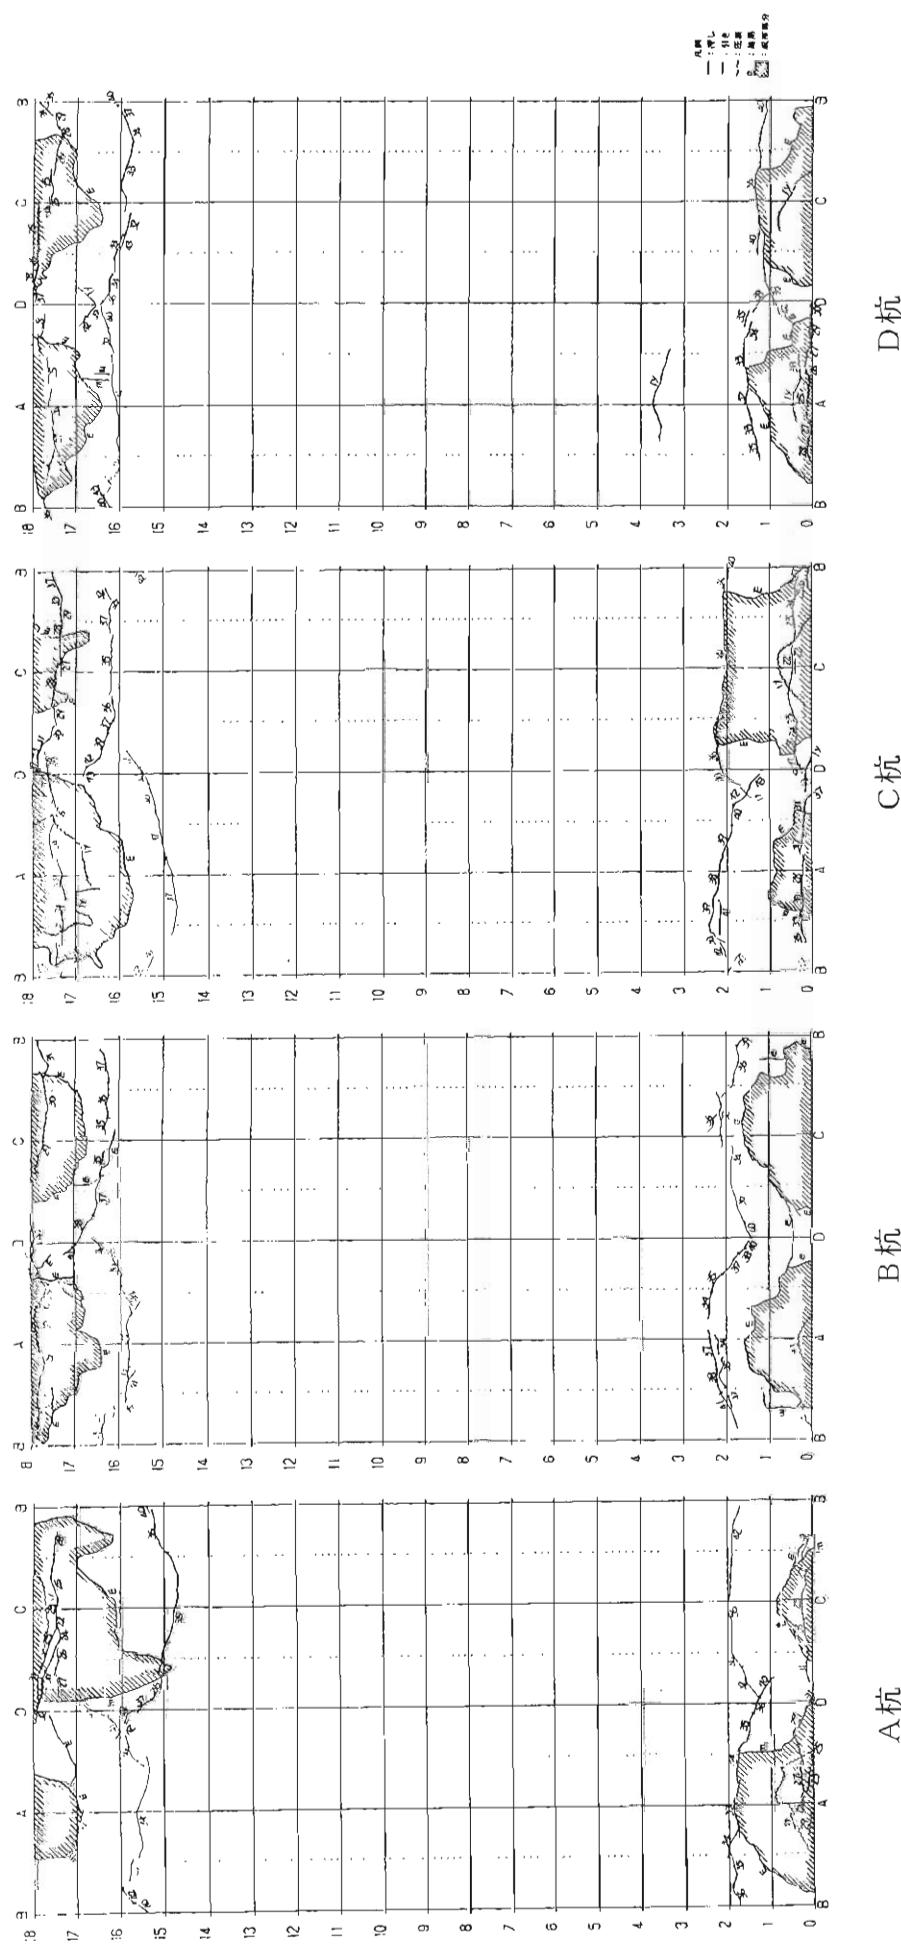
桁体のひび割れ状況展開図(ケース12、1δy)
